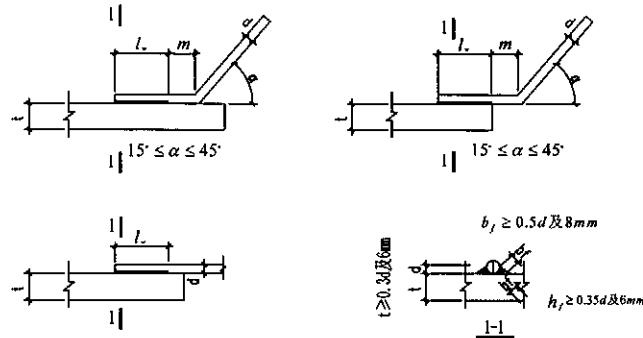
钢筋搭接电弧焊的焊接要求
